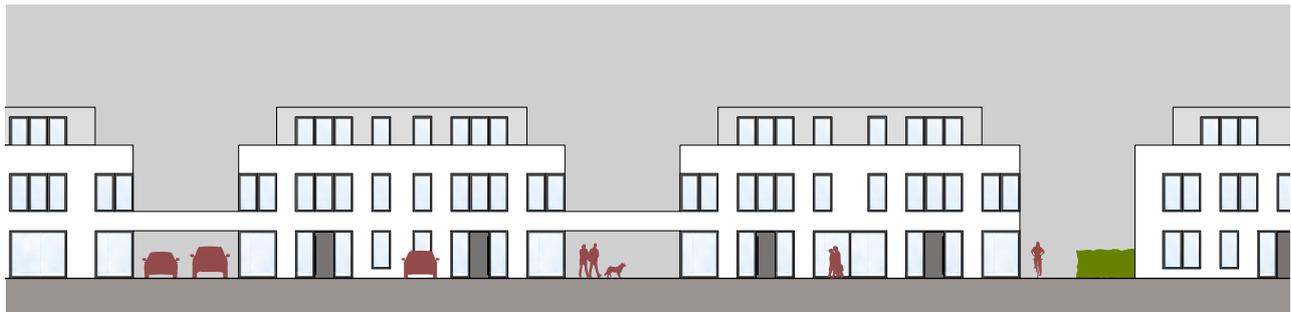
Ansicht rückwärtige Bebauung Hauptstraße
